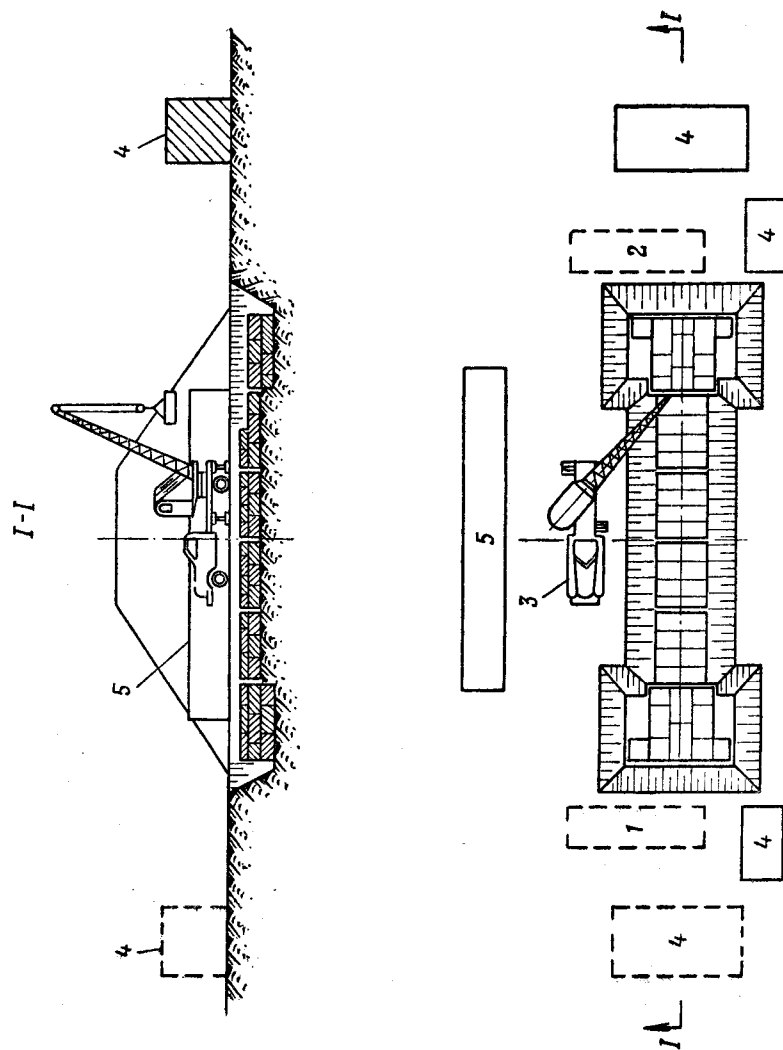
Схема строительной площадки по монтажу сборной железобетонной трубы:
